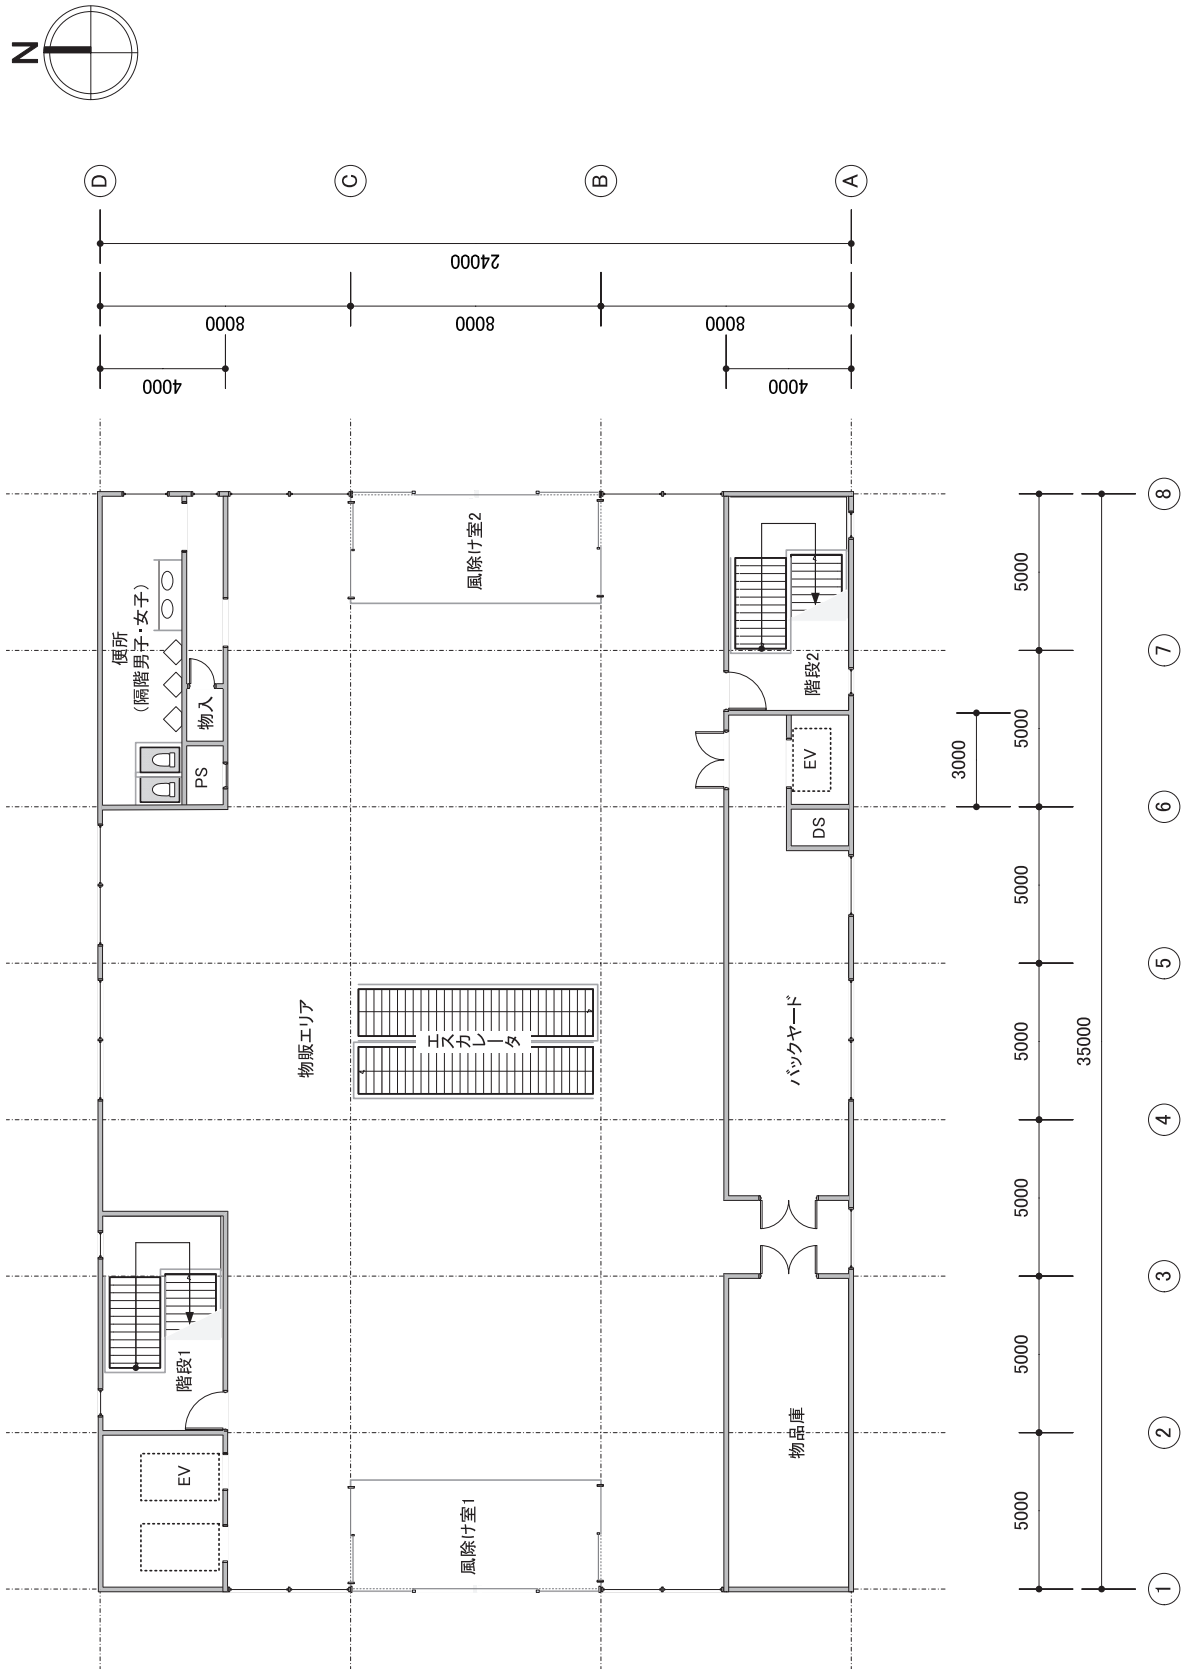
モデル建物 (物販店舗等、5,000㎡) 1階平面図
